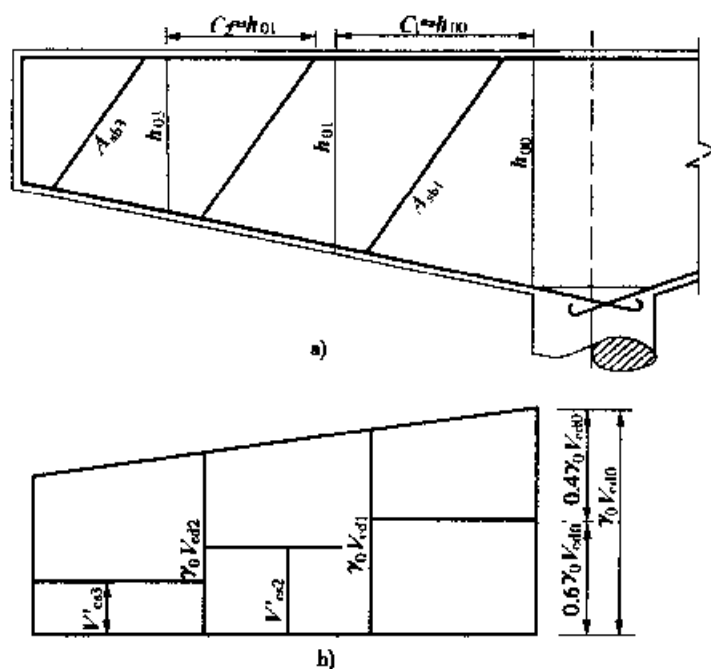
变高度钢筋混凝土梁斜截面承载力计算荷图
